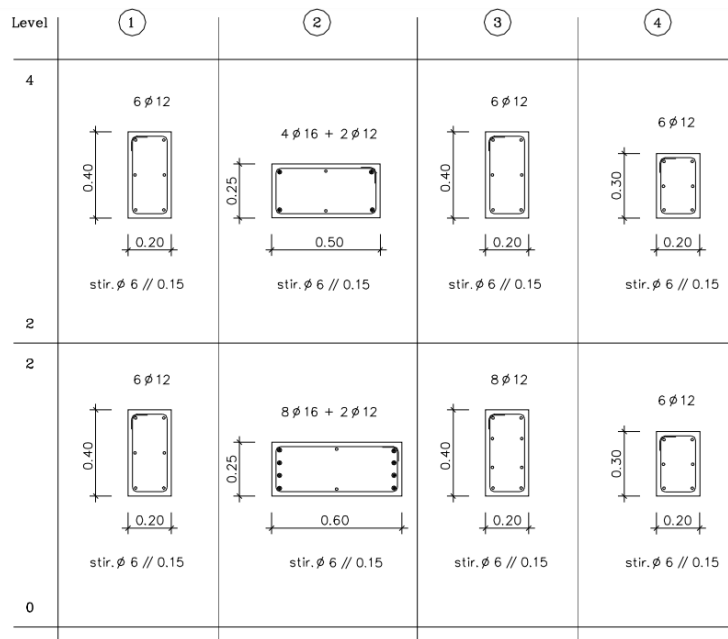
Geometria e pormenores de armadura dos pilares (Carvalho et al., 1999)
